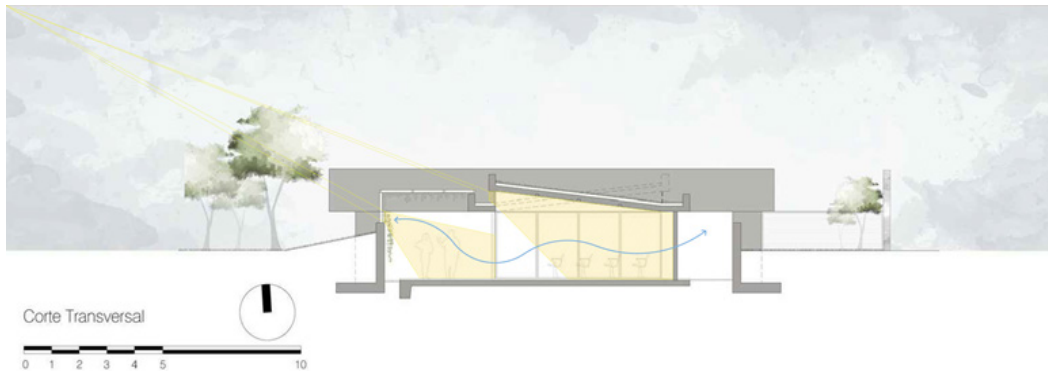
Corte Transversal con entradas de luz y aire. Fuente: Gonzales Moix Arquitectura, 2016.
